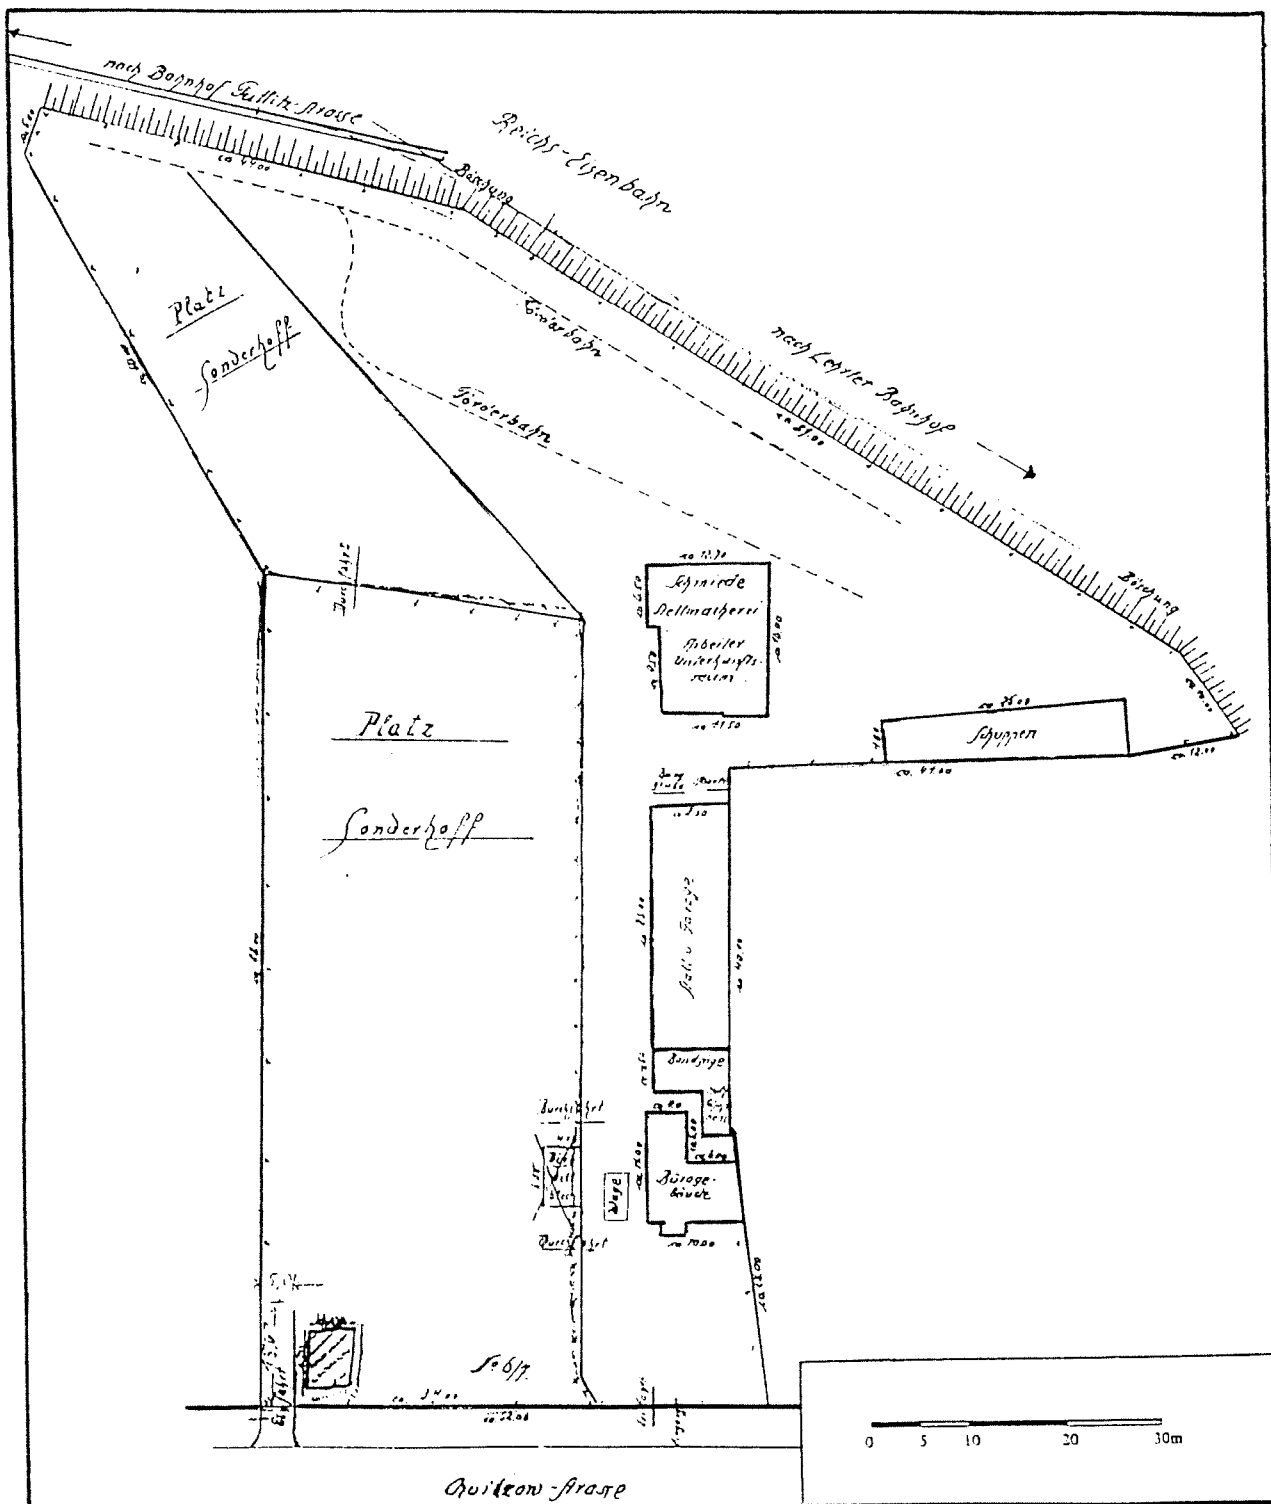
c : Verdachtsfläche 3 - Bebauungssituation 1927
